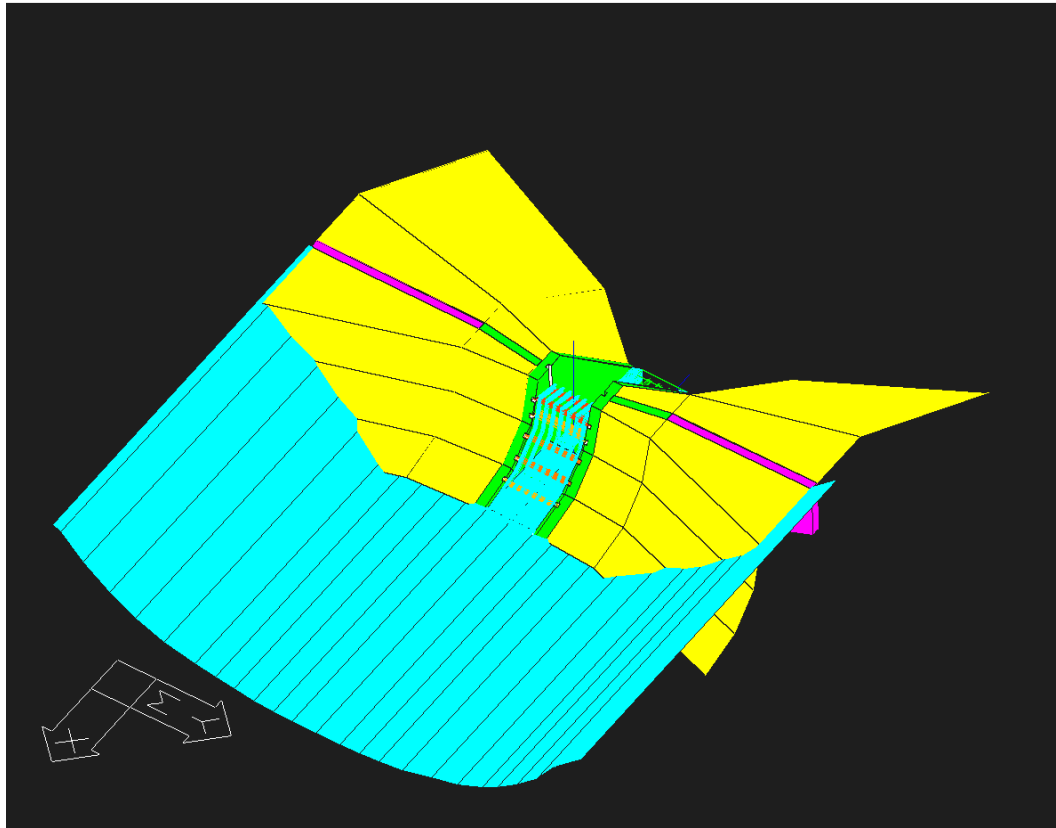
Scheibenbauwerk zur Geschiebedosierung und zum Rückhalt von Unholz und Muren; AUTOCAD-Zeichnung
